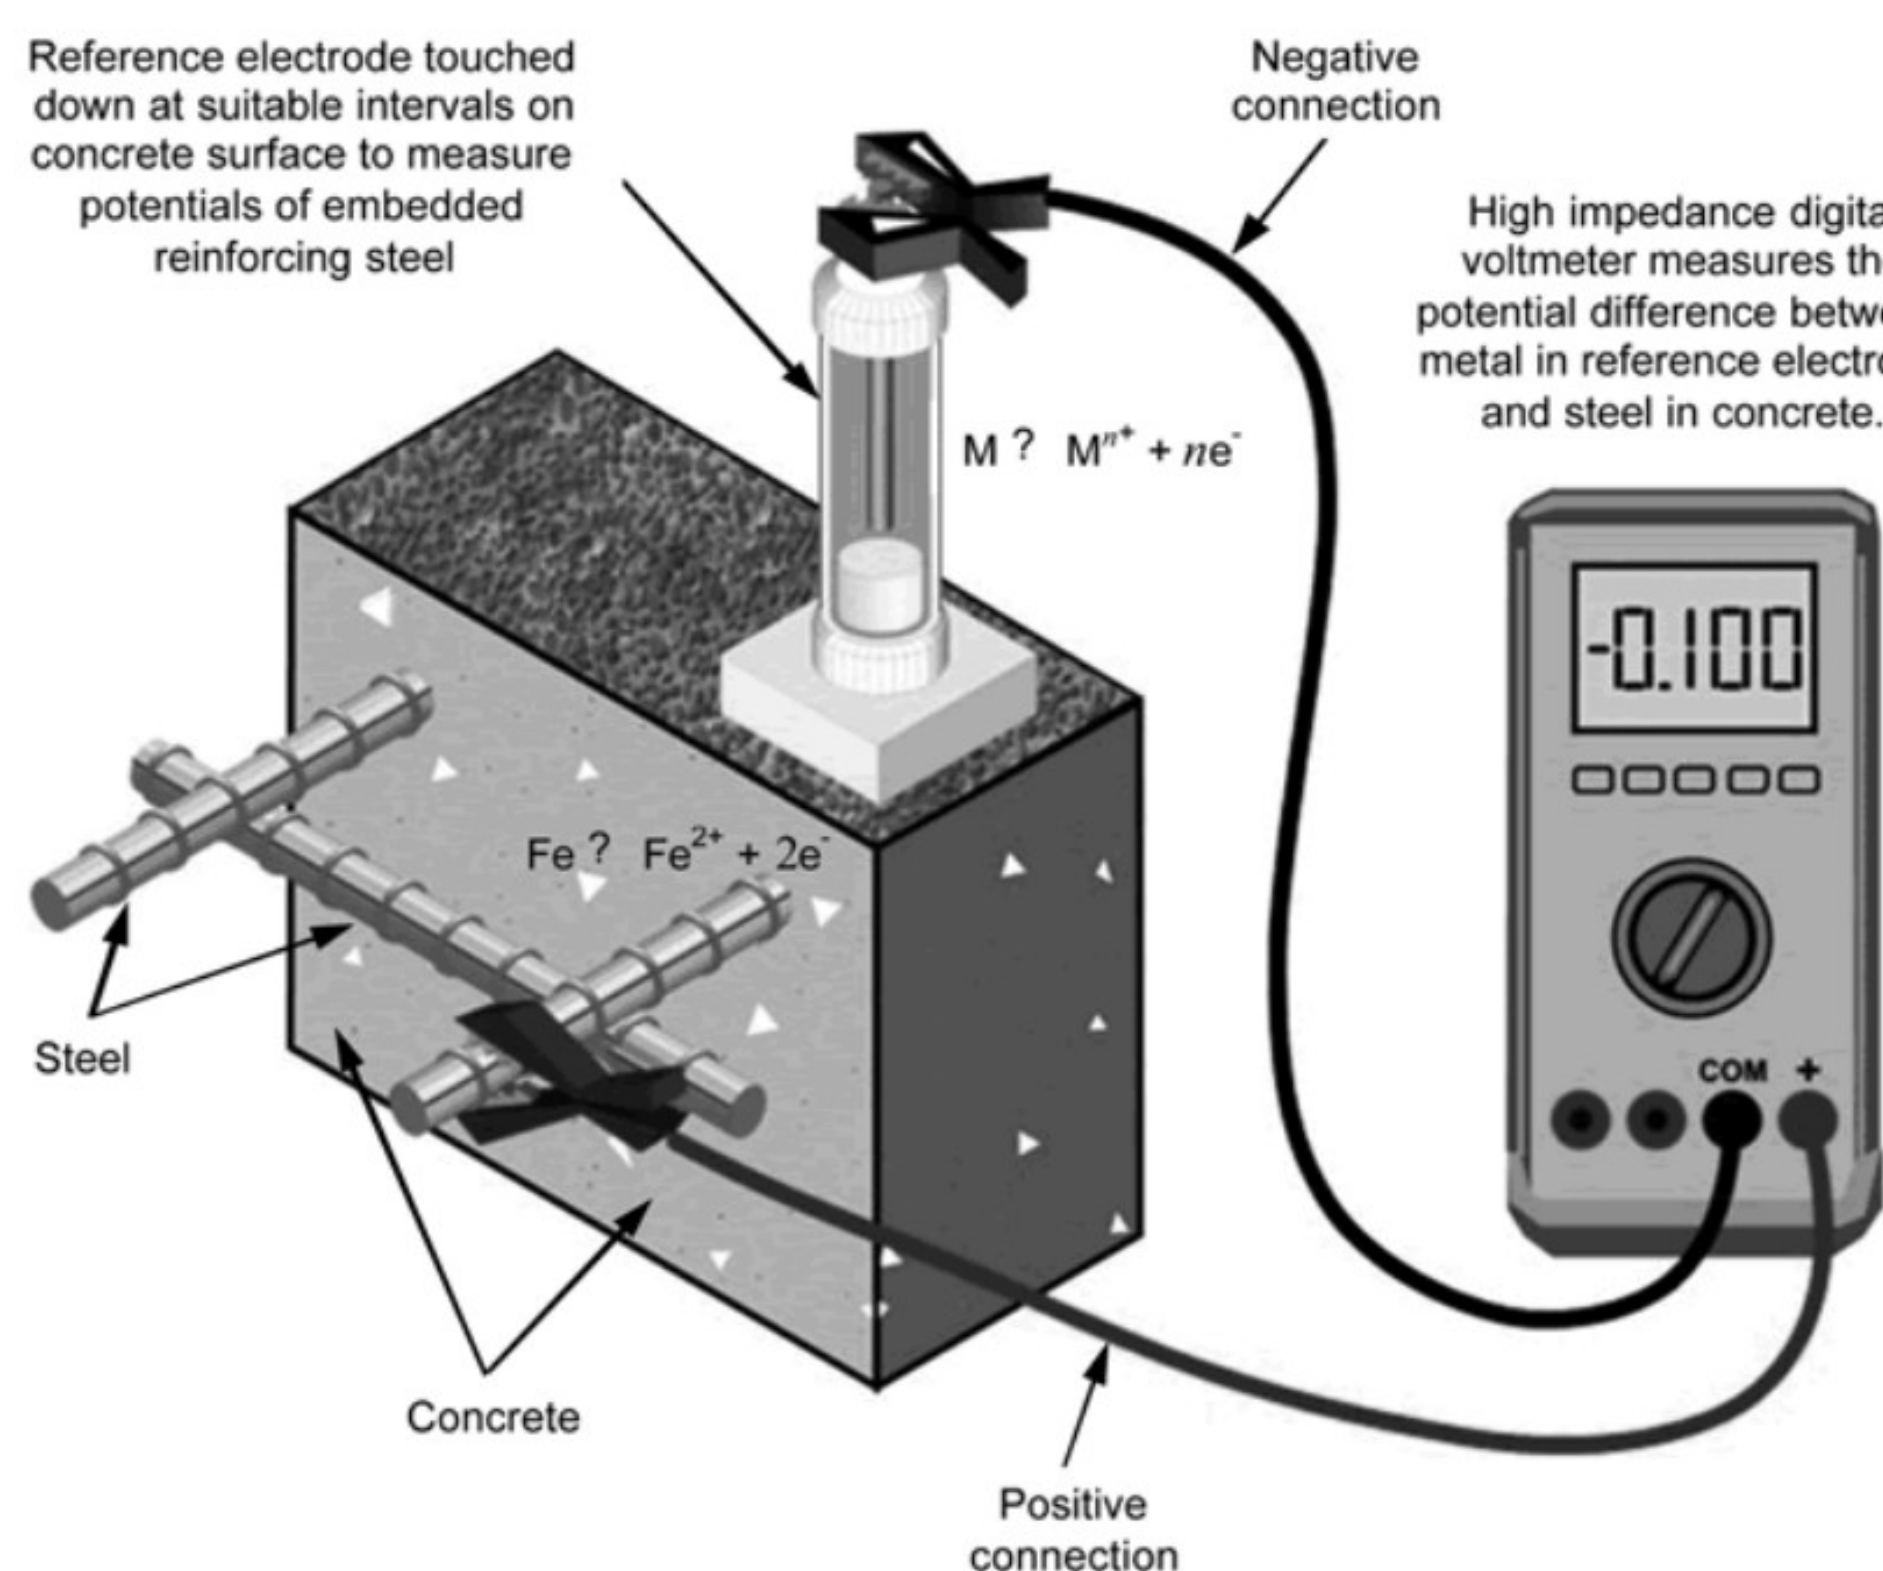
Medição do potencial de corrosão no concreto armado.
